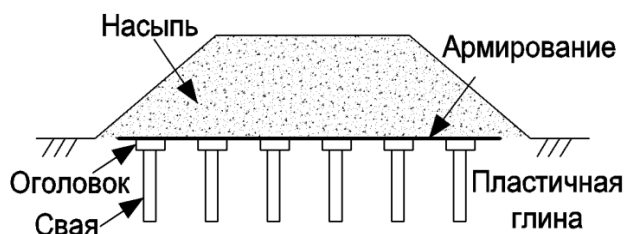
Насыпь на свайном основании с армированием низа насыпи
